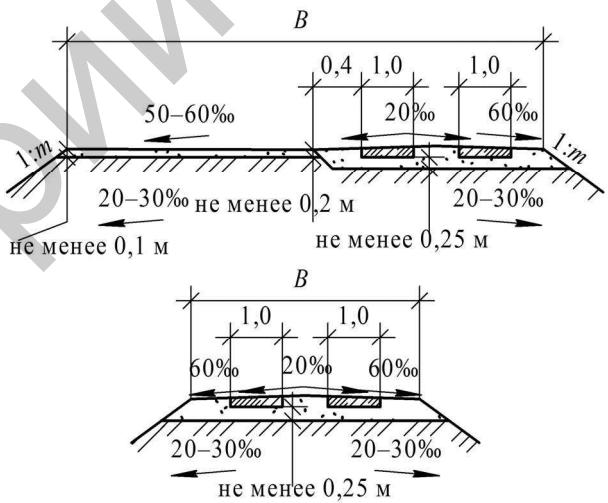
Поперечные профили колейных покрытий из железобетонных плит на постоянных путях
